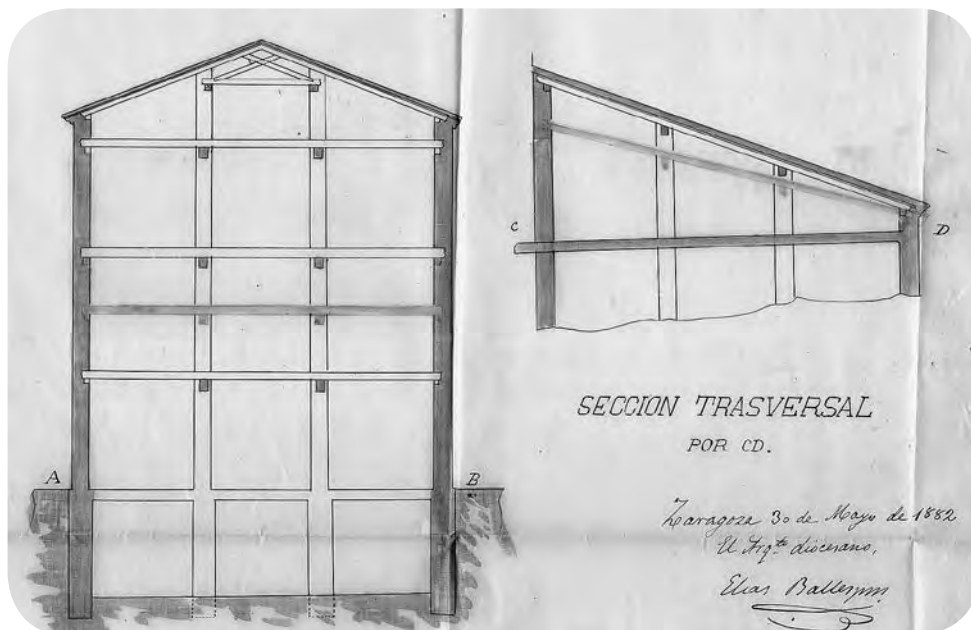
Sección. Proyecto de reparación del convento de la Concepción de Nuestra Señora, arquitecto Elías Ballespín, 1882. Plano A.D.T.
